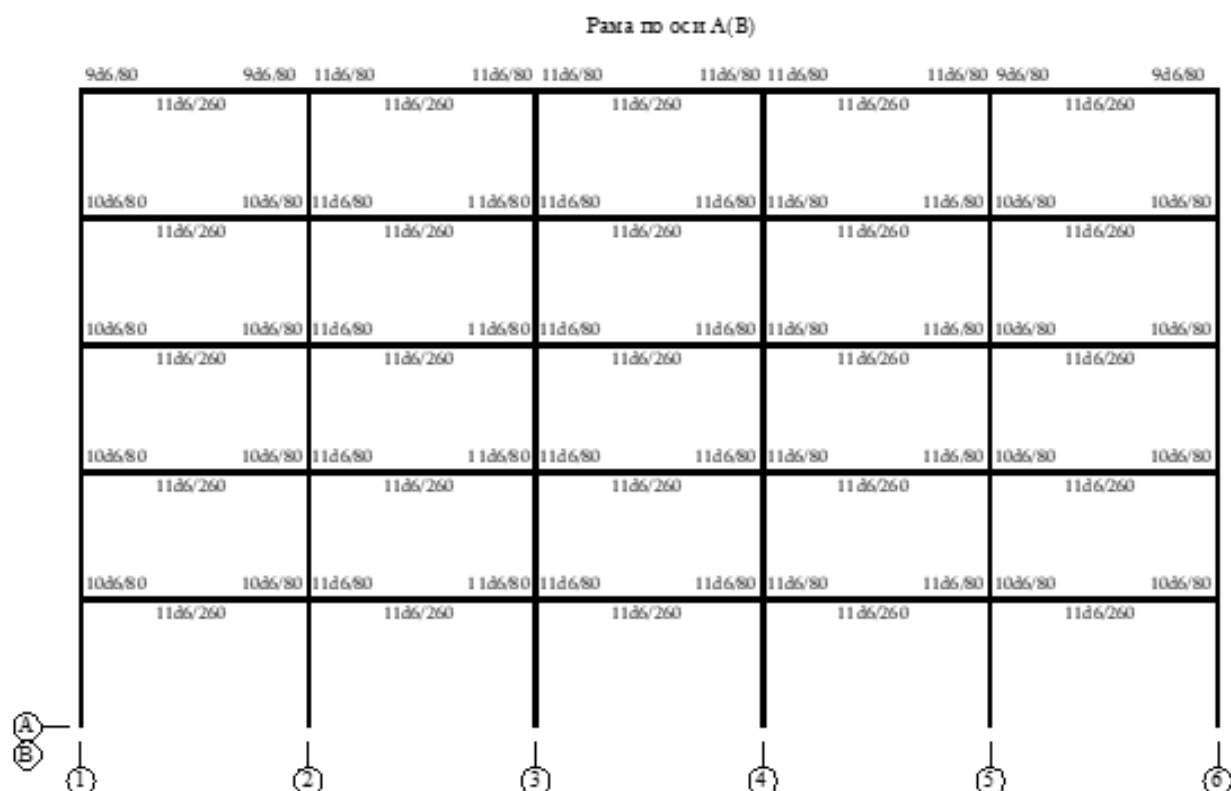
Поперечное армирование балок рам, расположенных по осям А, Б и В, в соответствии с результатами расчета
